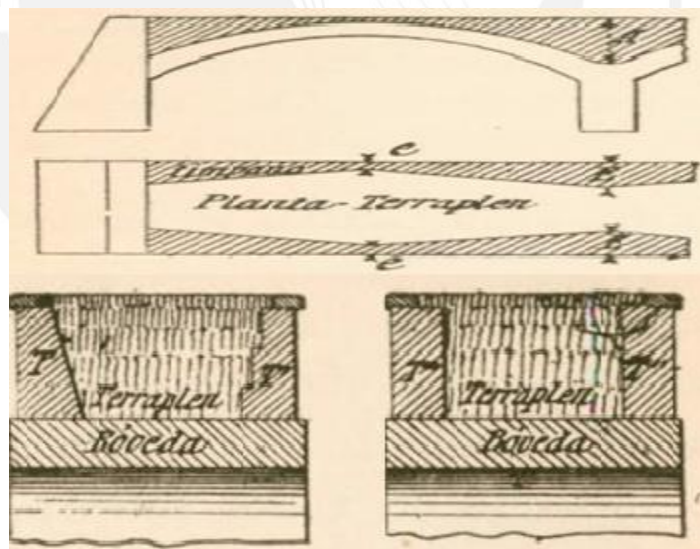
Elevación, planta y secciones transversales típicas de los tímpanos que eran construidos.
